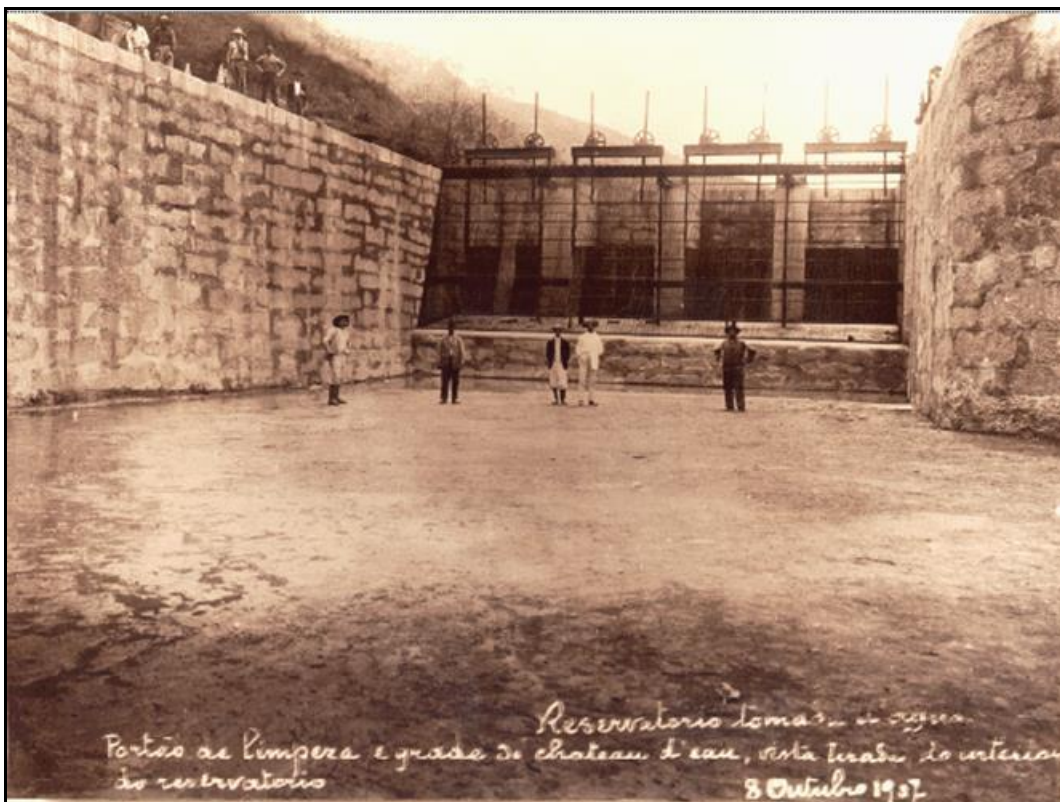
Construção da barragem. Fonte: (ME, 2000)
